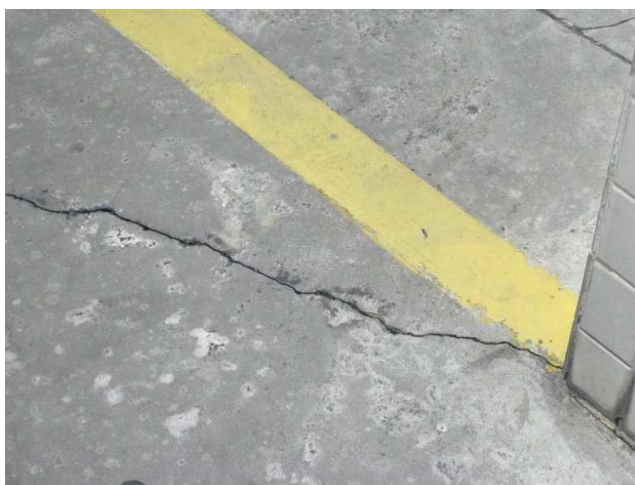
Fissura no 2º piso do pavimento garagem
